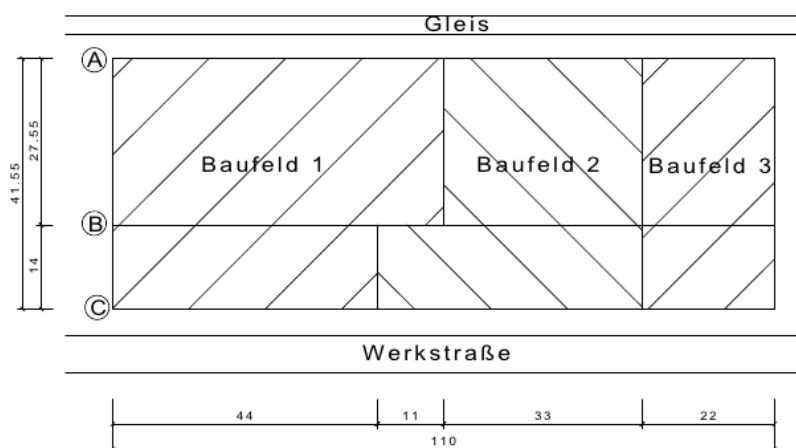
Grundriss mit Baufelddarstellung
